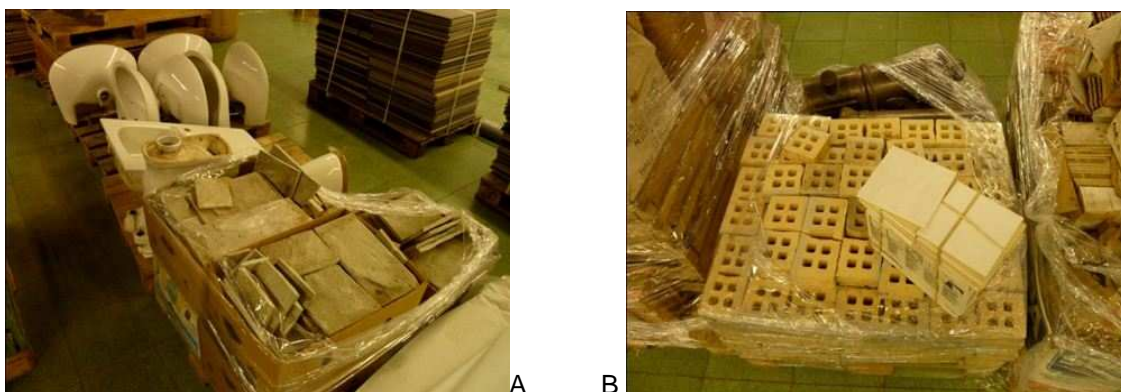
A) Sanitaires et dalles de carrelage – B) Briques
